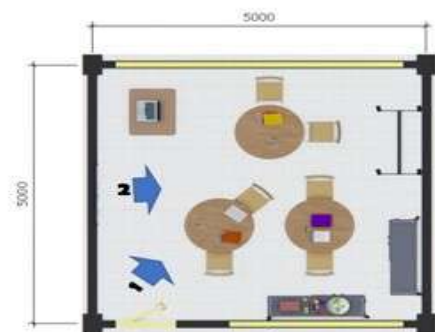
Denah & Perspektif interior Ruang Dosen
